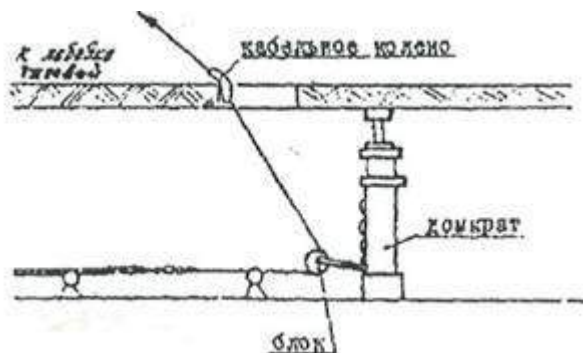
Схема присоединения стального каната к тяговой лебедке и кабеля к канату
